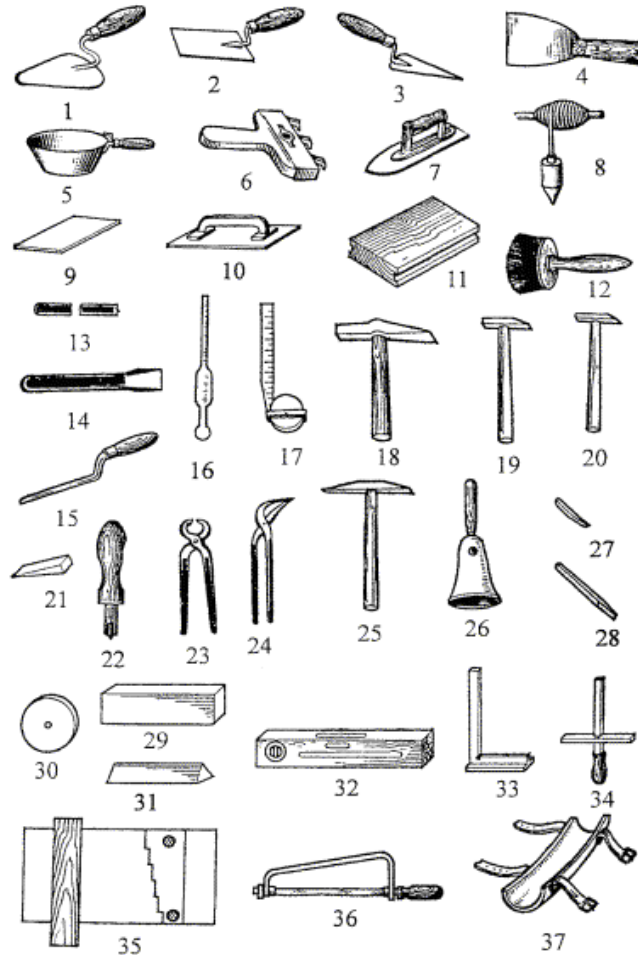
Ручний інструмент облицювача-плиточника: 1 - звичайна лопатка; 2 – прямокутна лопатка; 3 - відрізування; 4 – сталевий шпатель; 5 – штукатурний ківш; 6 - подряпання; 7 - прасування; 8 - виска масою 150 г; 9 – гумовий шпатель; 10 - хлопавка; 11 – брусок; 12 – пензель; 13 - шлямбур; 14 - скарпель; 15 - пазовий ущільнювач; 16 – ареометр; 17 – рулетка довжиною 2 м; 18 – молоток масою 600 г; 19, 20 - плиткові молотки масою 80 та 60 г; 21 - дубовий клинок довжиною 5 см; 22 - сталевий різець з наконечником із твердого сплаву, 23, 24 - кліщі; 29 – карборундовий брусок; 30 - карборундове коло; 31 – тригранний брусок; 32 – рівень; 33 - сталевий косинець; 34 - шаблон; 35 - шаблон А.С. Афоніна; 36 - ножівка; 37 – наколінник.
